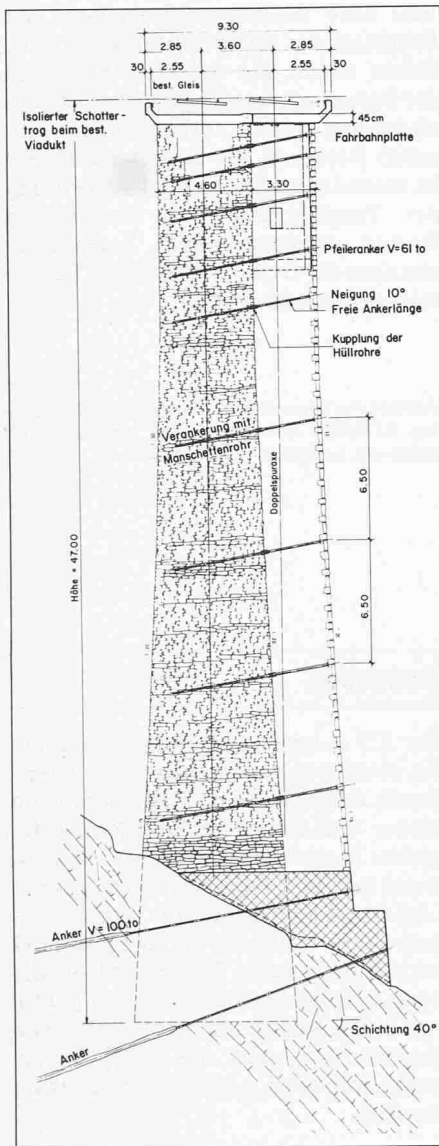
Pfeiler mit Verbundanker; Fundation. Querschnitt
